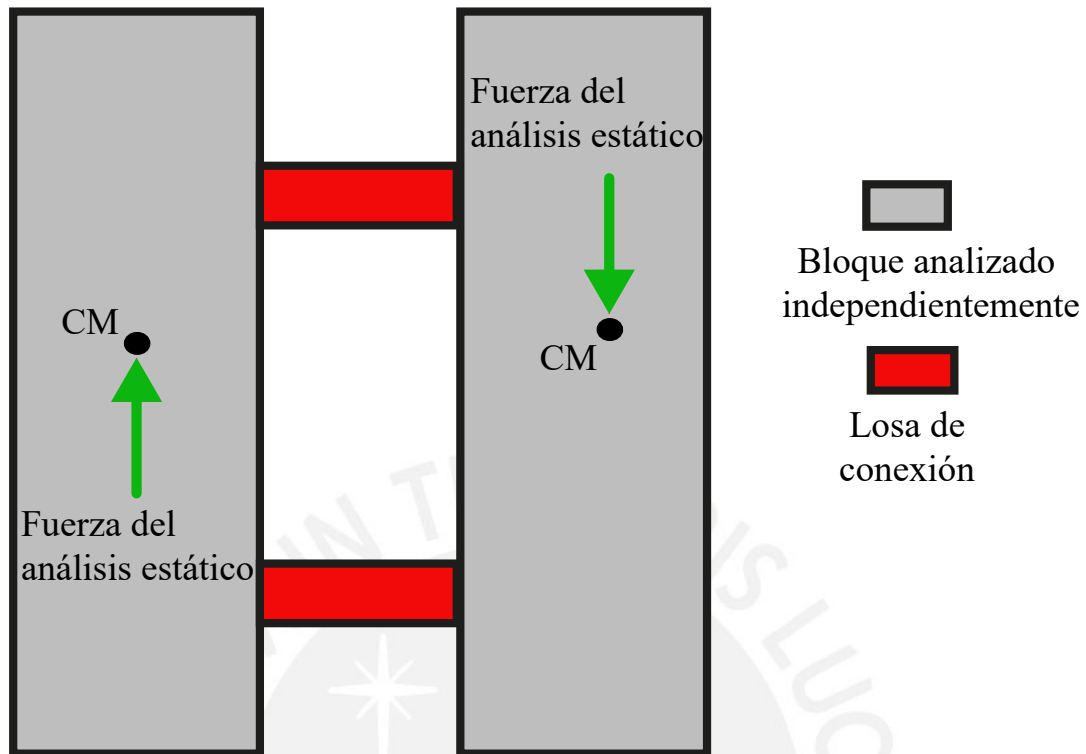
Planteamiento del análisis para el cálculo del peralte en losa de conexión
